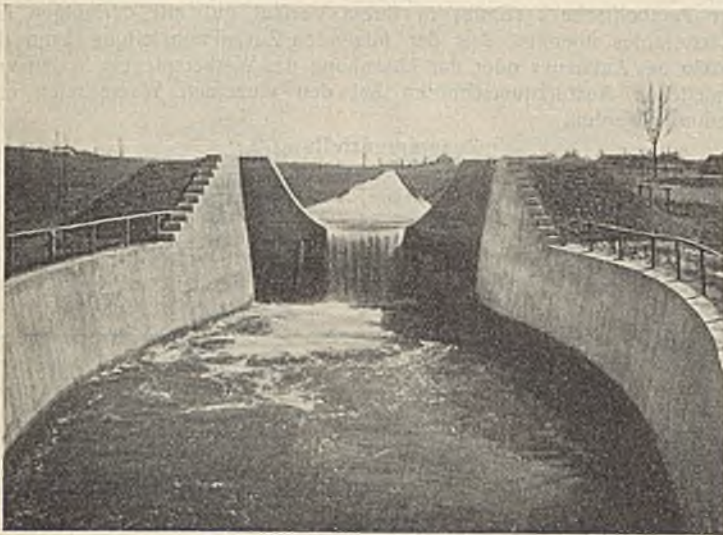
Absturzbauwerk in der Strogen bei Langenpreising, parabelförmiger Absturzquerschnitt, bauchige Grundrißform des Absturzbettes (Kulturbauamt München).
